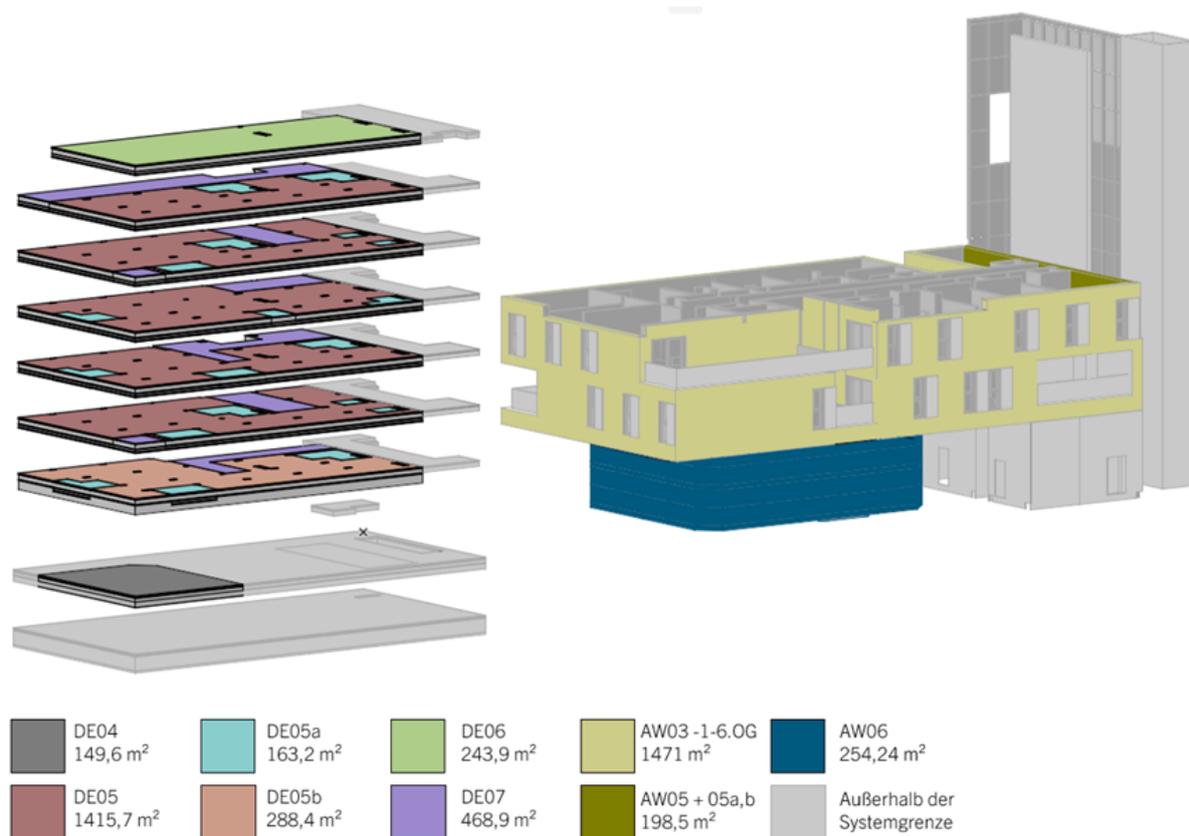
Lage und Fläche der betrachteten Bauteilaufbauten im Projekt, Quelle: Eigene Darstellung
